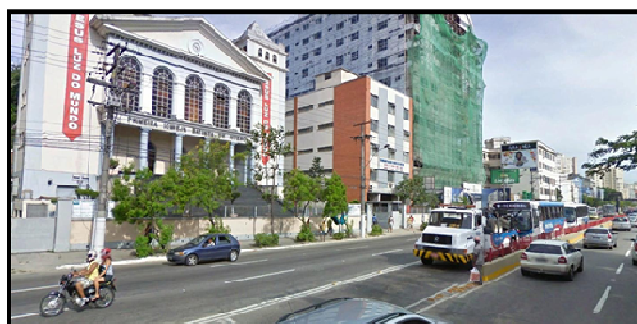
Vista parcial do local da passagem subterrânea da praça Renascença.
